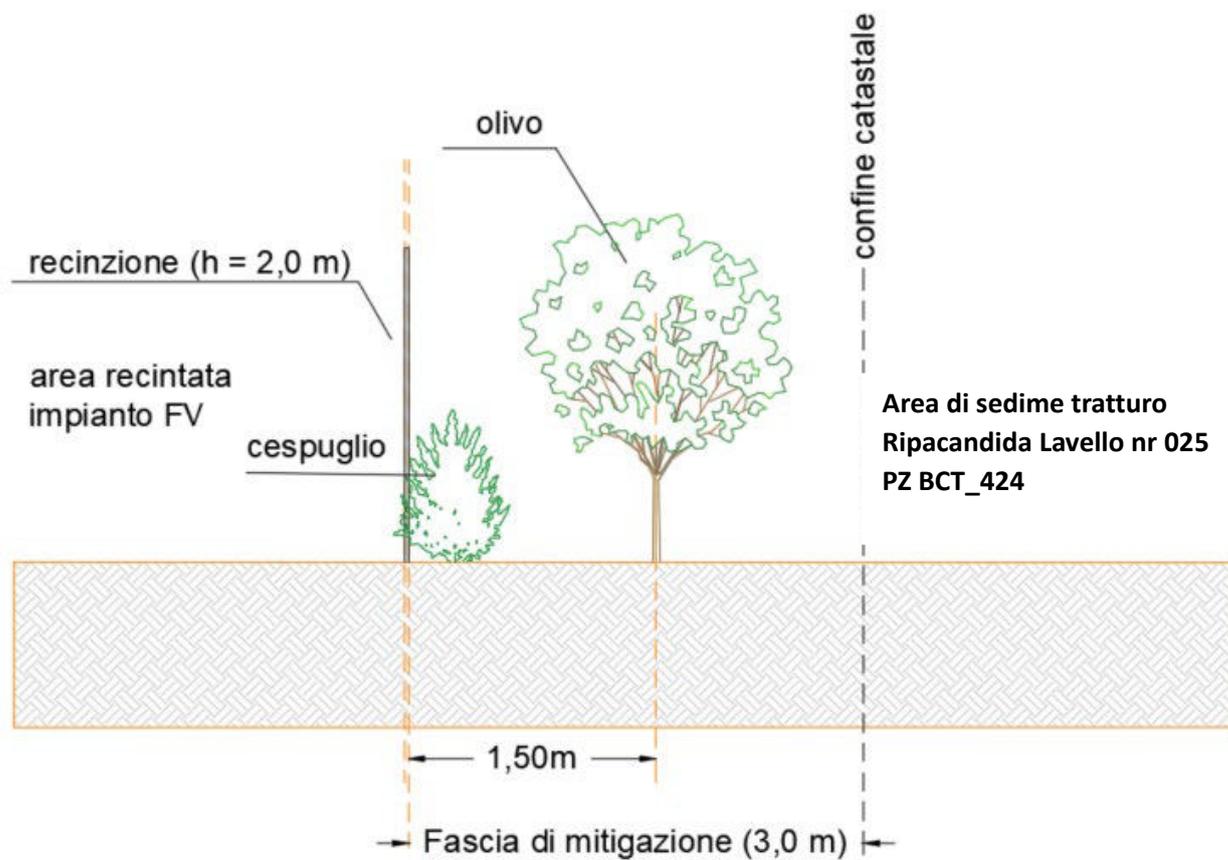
Stralcio di sezione dell'area perimetrale dell'impianto.
